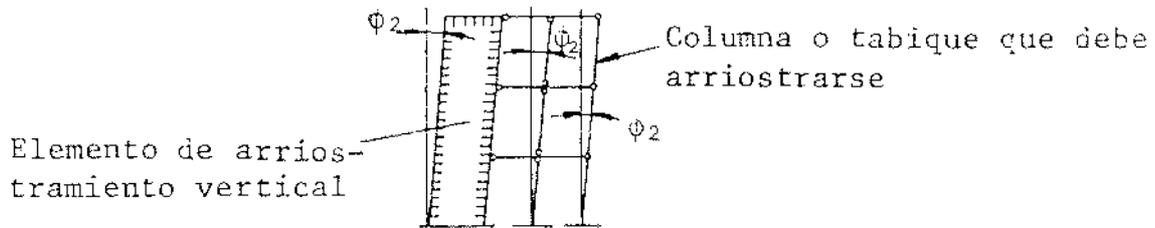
Inclinación ϕ_2 de todos los componentes verticales de arriostramiento y a ser arriostrados
